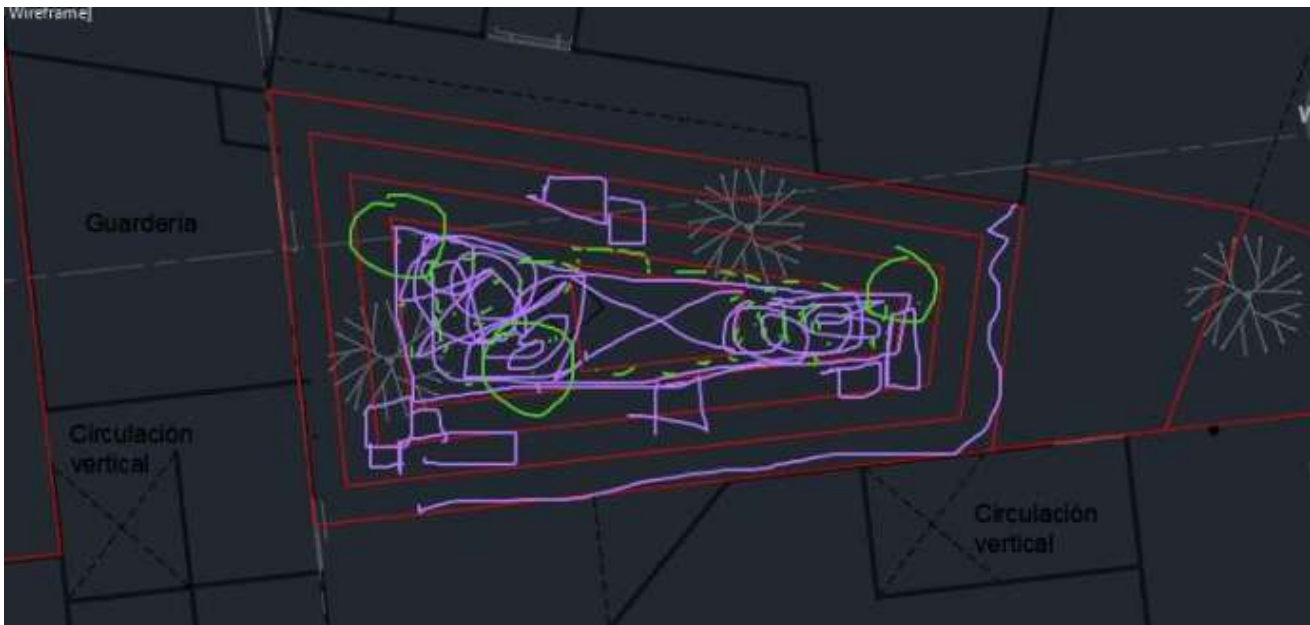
Planta arquitectónica intervenida con análisis de circulaciones. Fuente: Autoría propia
